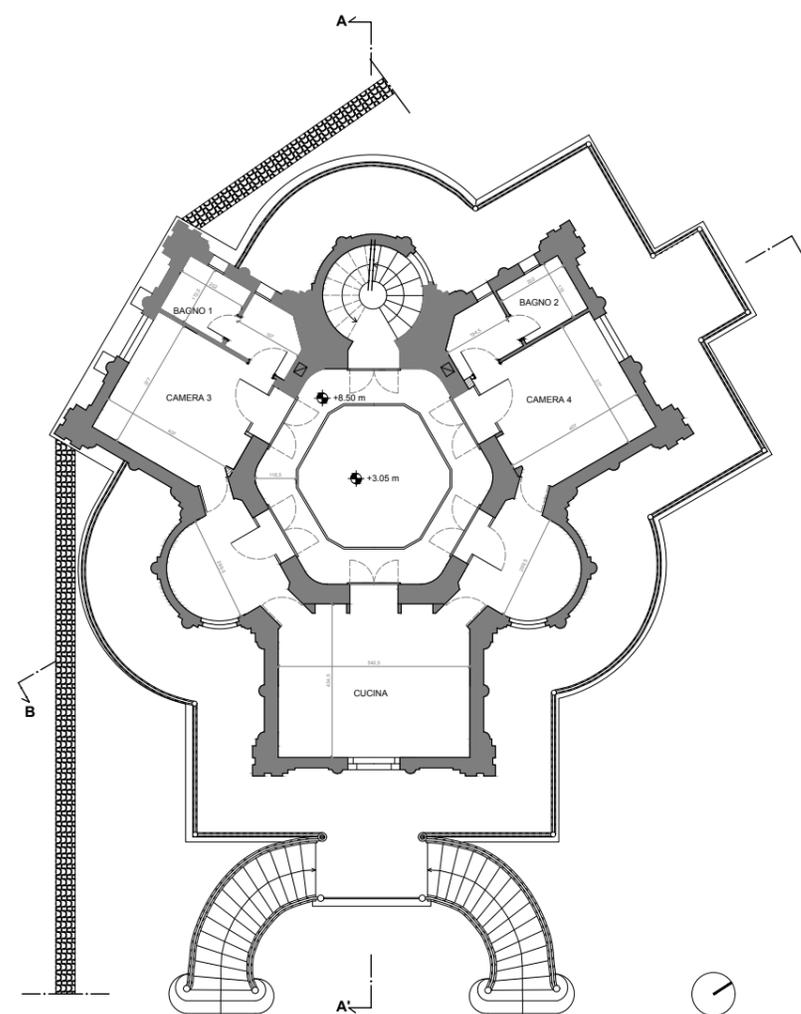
\_Pianta piano secondo La Bizzarria - scala 1:200
